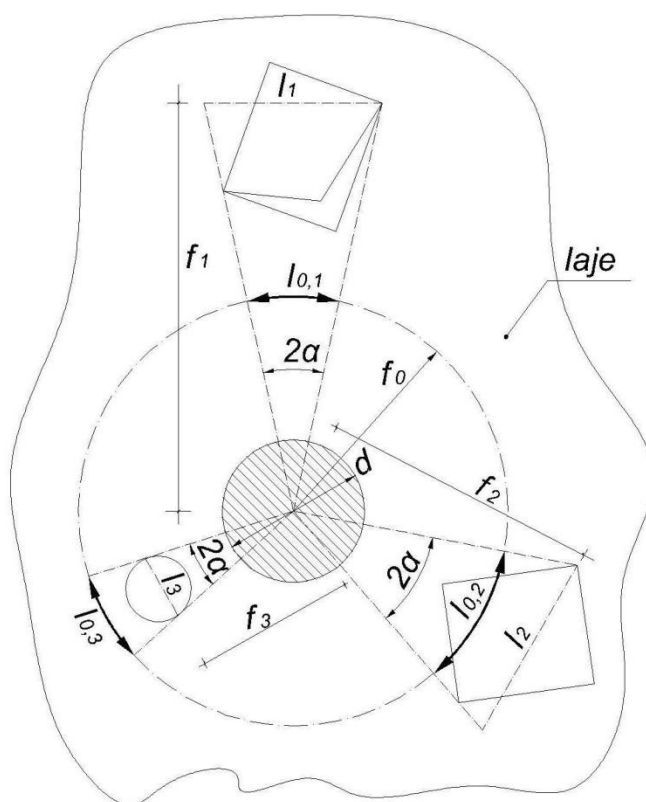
Esquema de laje com aberturas próximas do pilar.
